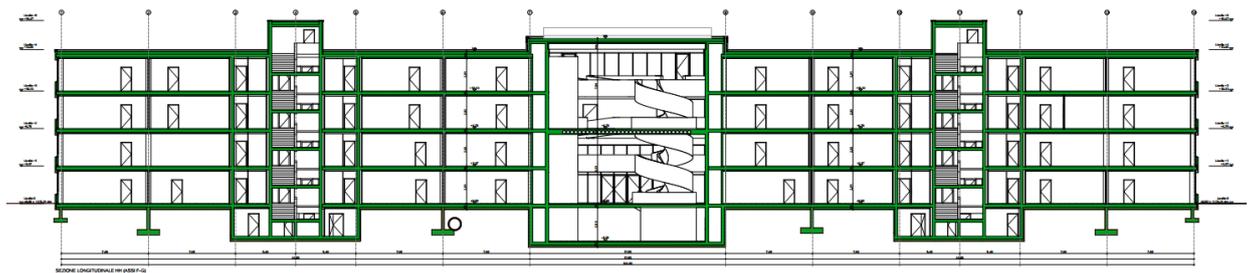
Sezione longitudinale HH – Durisch + Nolli Architetti sagl
